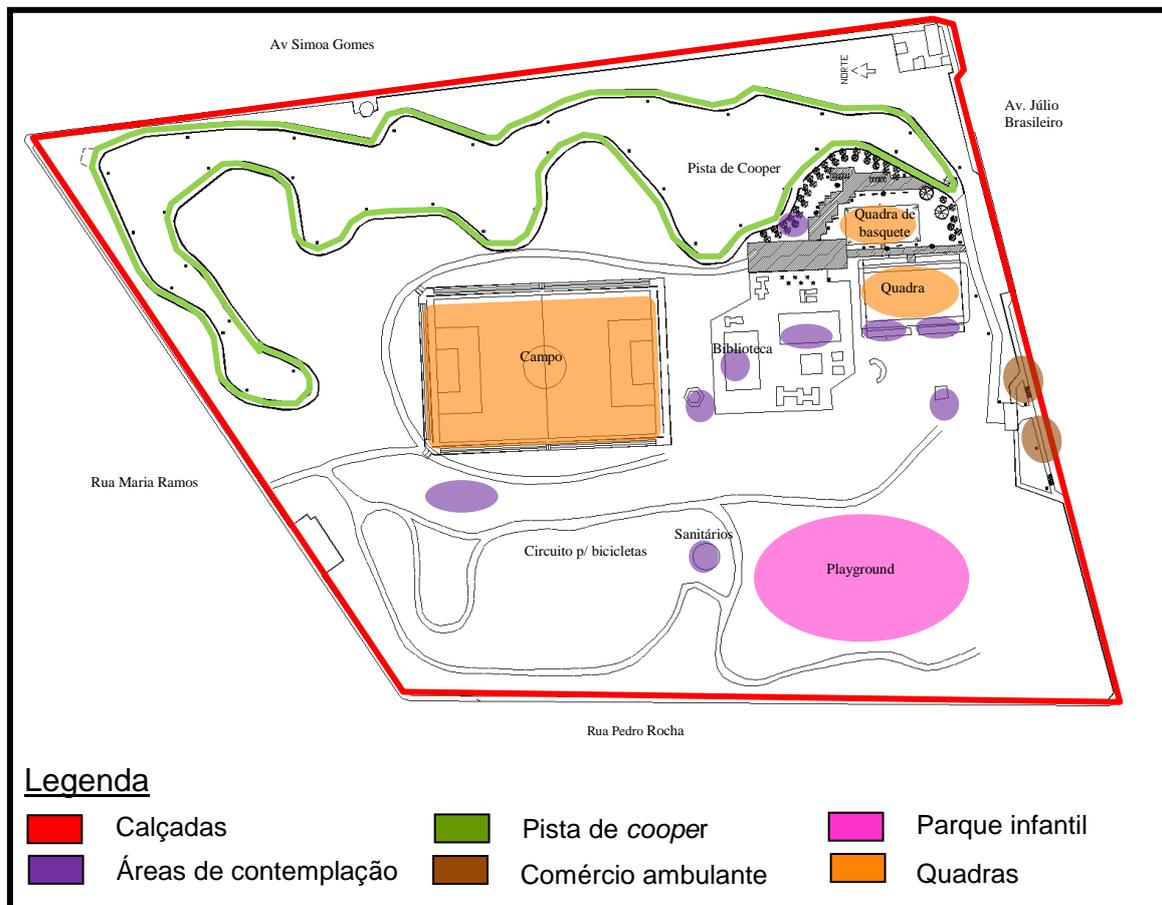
Planta Baixa da Academia da Cidade de Garanhuns
